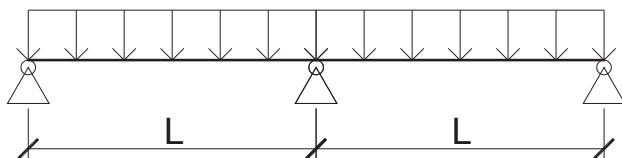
Схема нагружения - неразрезная двухпролетная балка.
